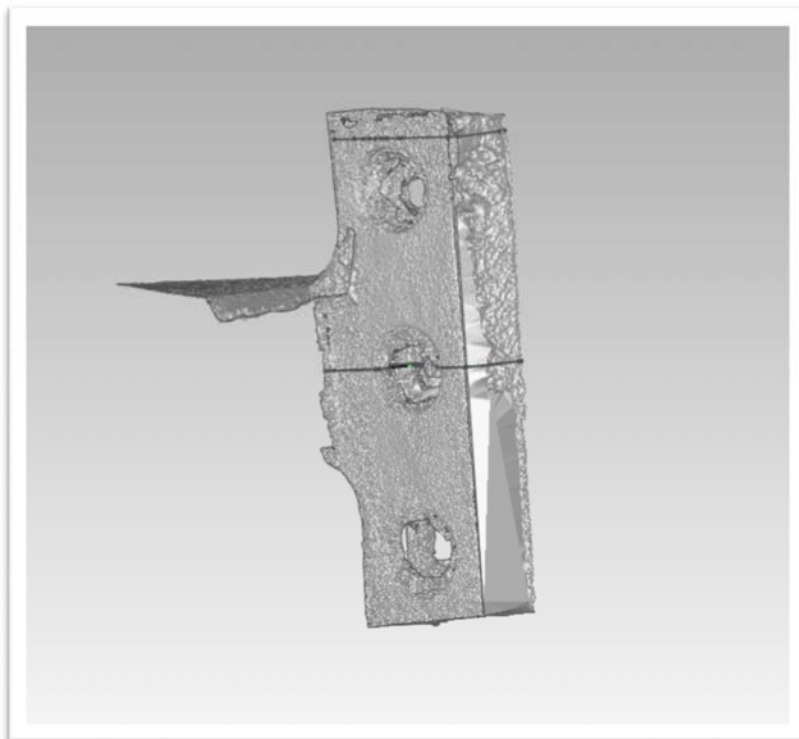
Secciones transversales realizadas (Fotogrametría)
